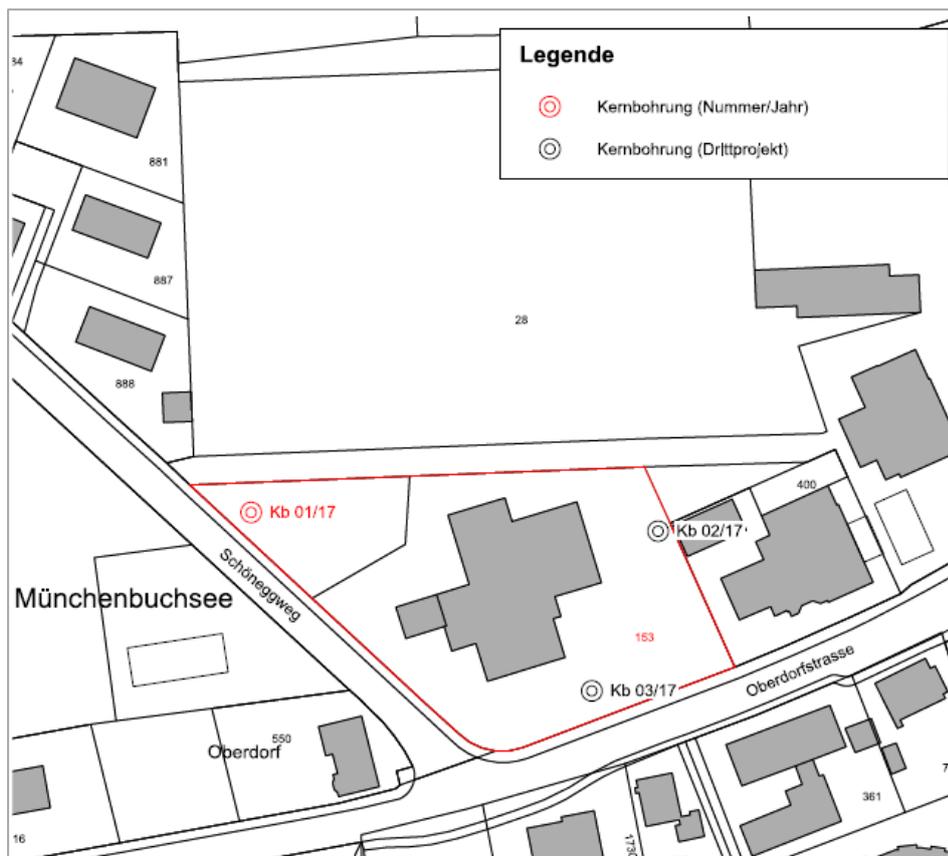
Situation Kernbohrung Baugrunduntersuchung
